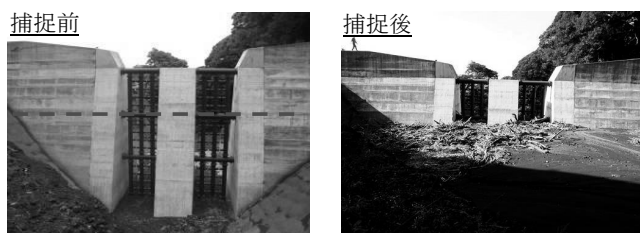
平面構造(T型)の土石流捕捉前後状況
